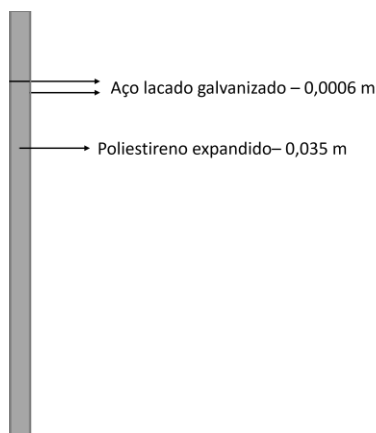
Corte transversal da porta interior e da porta de acesso externo a B
